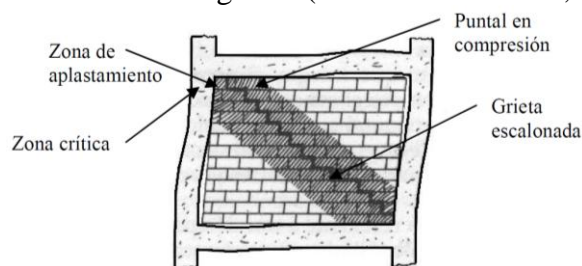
Falla por aplastamiento por compresión diagonal en muro de mampostería no estructural (Astroza & Schmidt, 2004).
